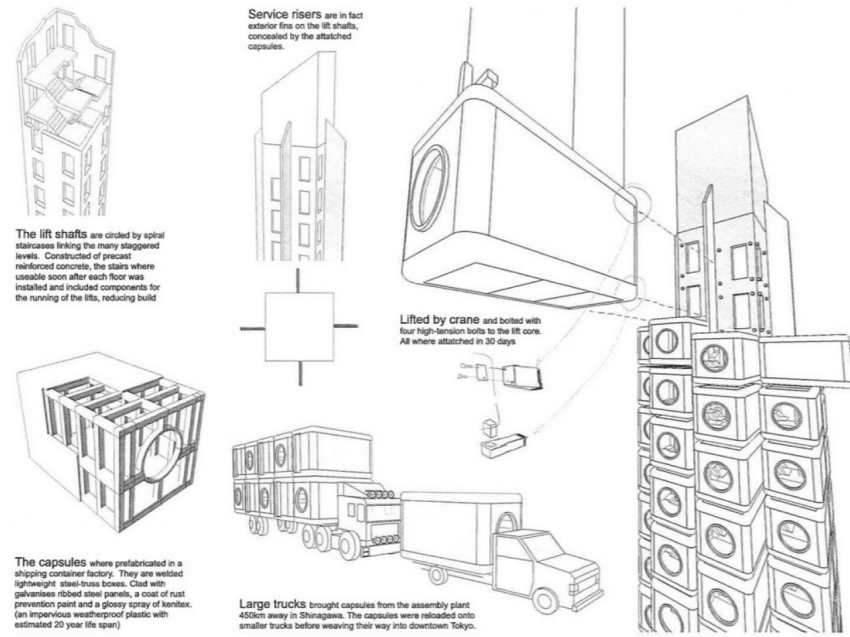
Esquema de proceso de construcción, transporte y montaje.
